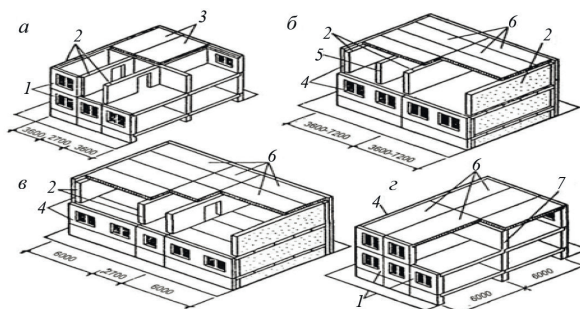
Конструктивні схеми безкаркасних великопанельних будівель:
